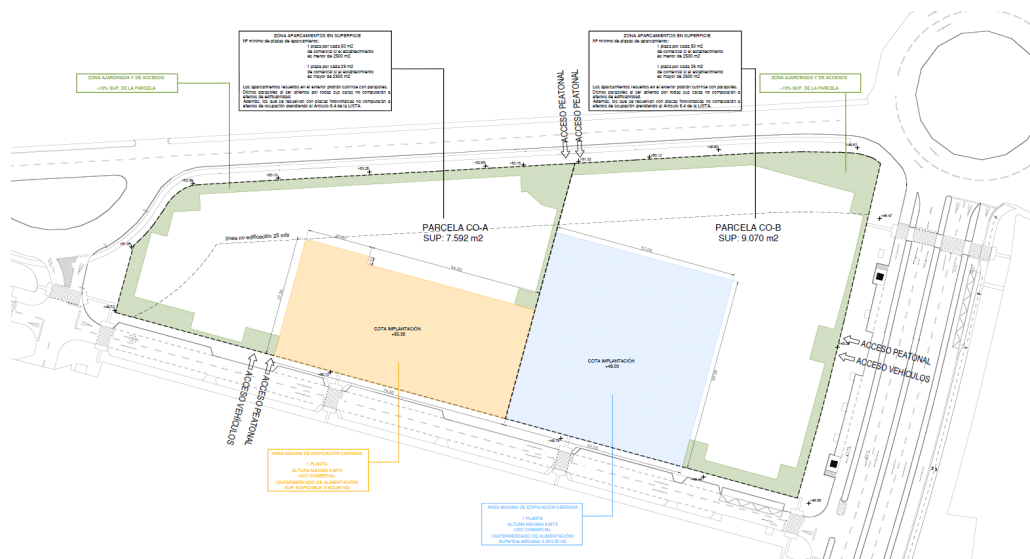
Plano 8. Plano Normativo de Ordenación de Volúmenes.
